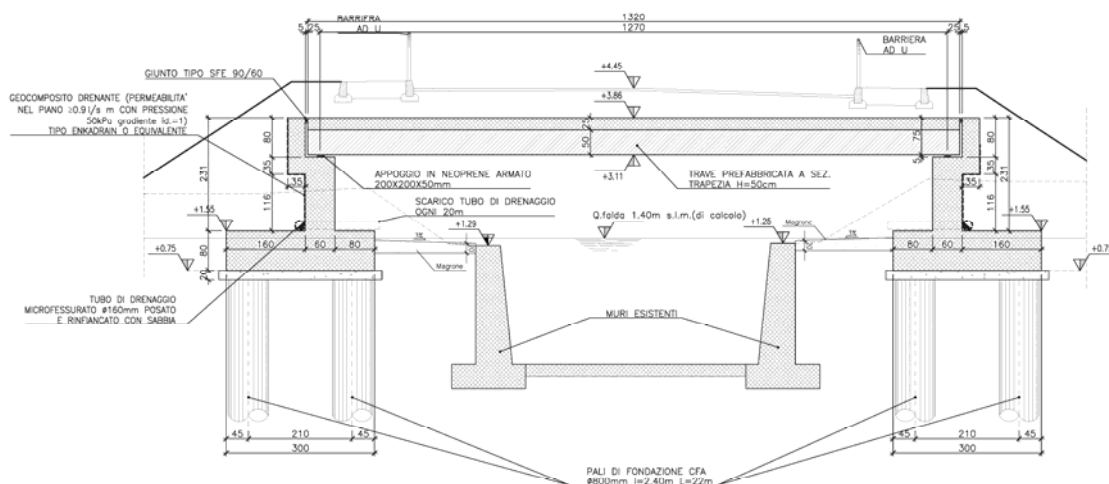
Impalcati 8 e 9 –Sezione trasversale
